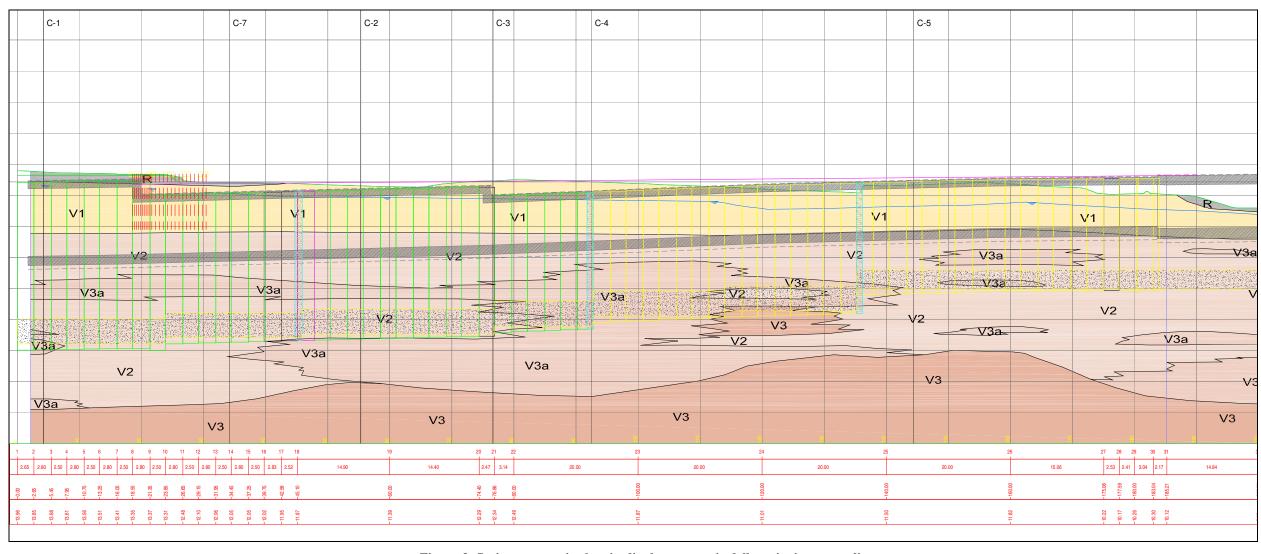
Sezione geotecnica longitudinale con traccia delle sezioni trasversali
